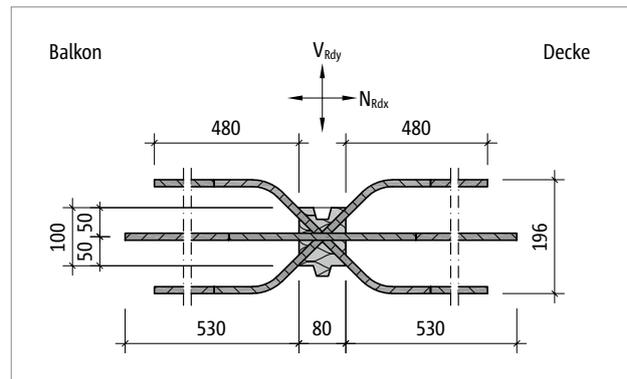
Schöck Isokorb® T Typ HP-VV2-NN1: Produktgrundriss
